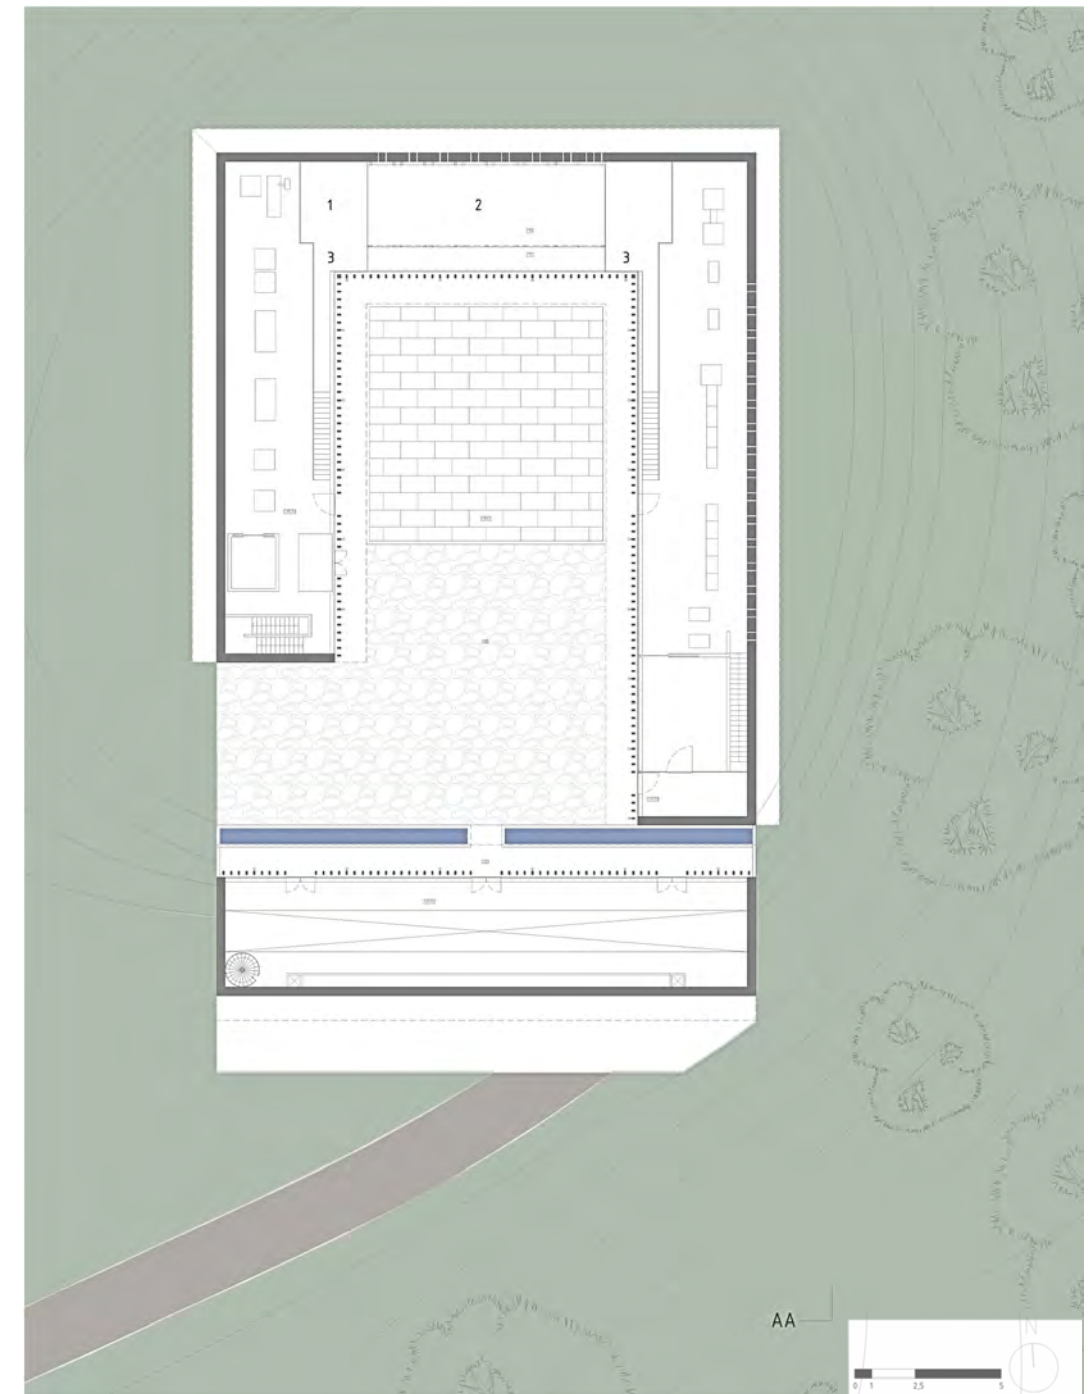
Planta Piso 1: 1- Zona de Chegada do pinhão para secar; 2- Zona de secagem; 3 - Galeria de circulação/ visita
